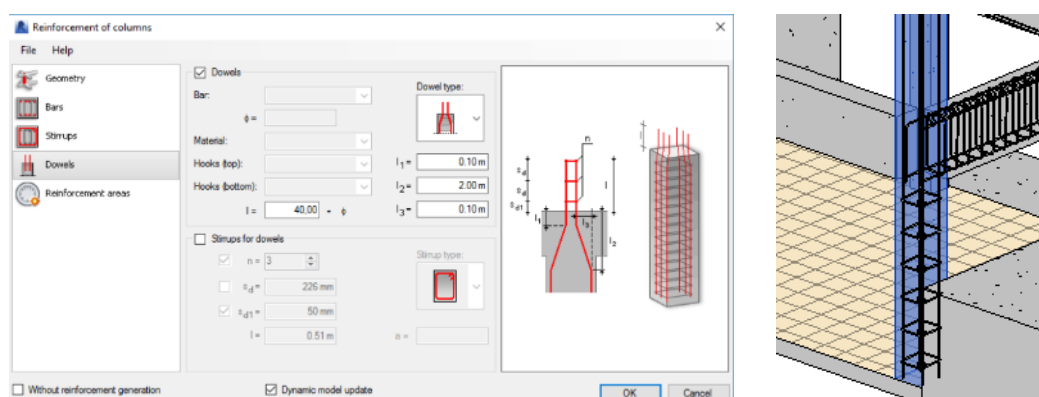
Interface e exemplo de modelação em pilares com a extensão em Revit
